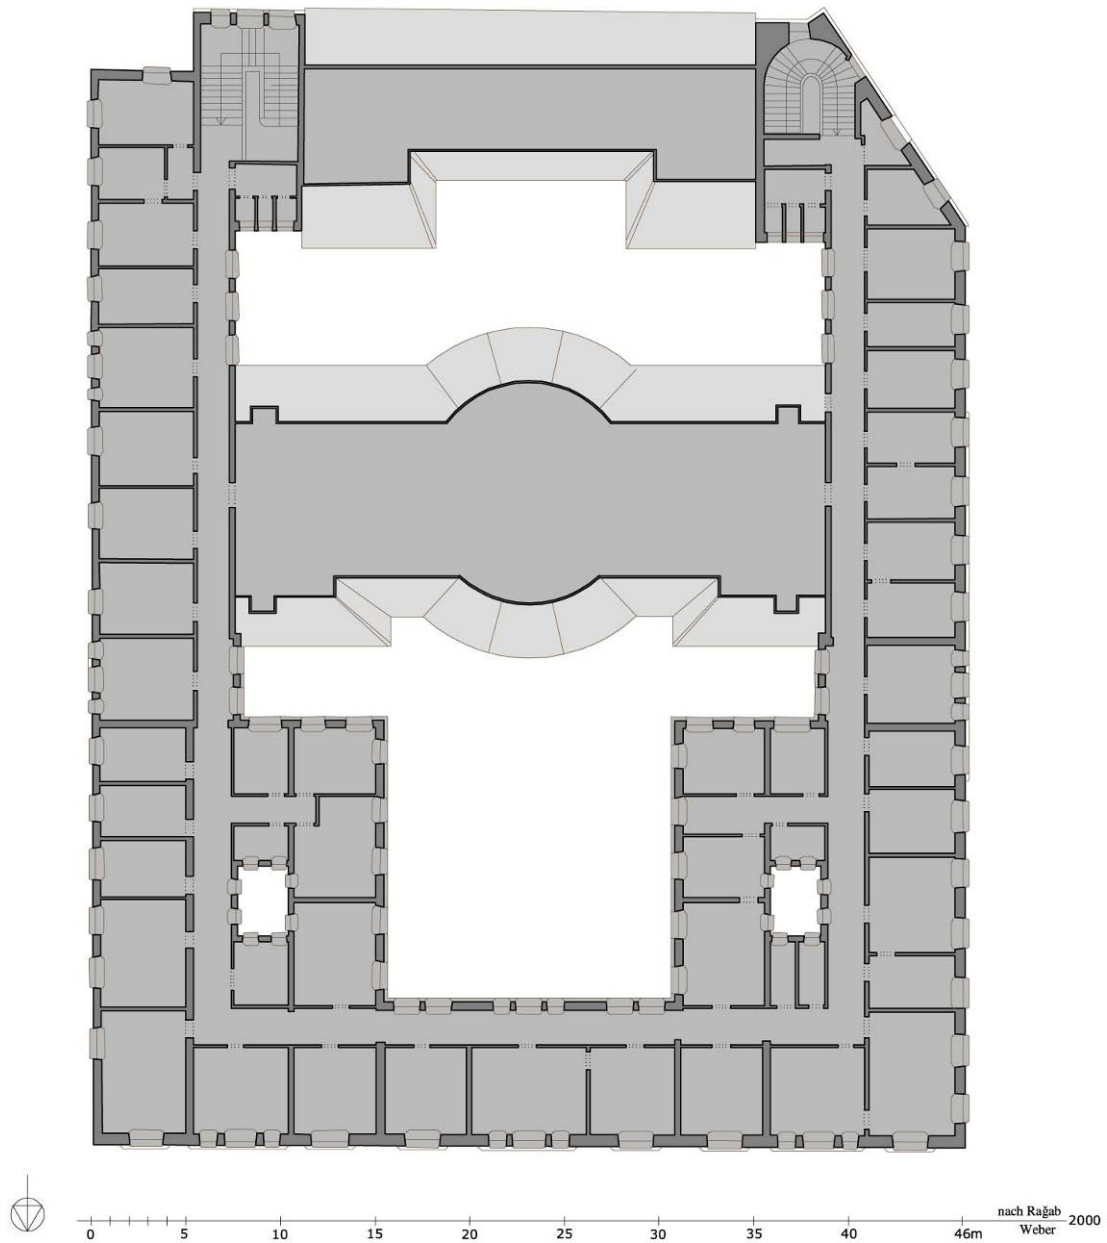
Handelsgebäude al-ʿĀbid, Grundriss 3. OG
